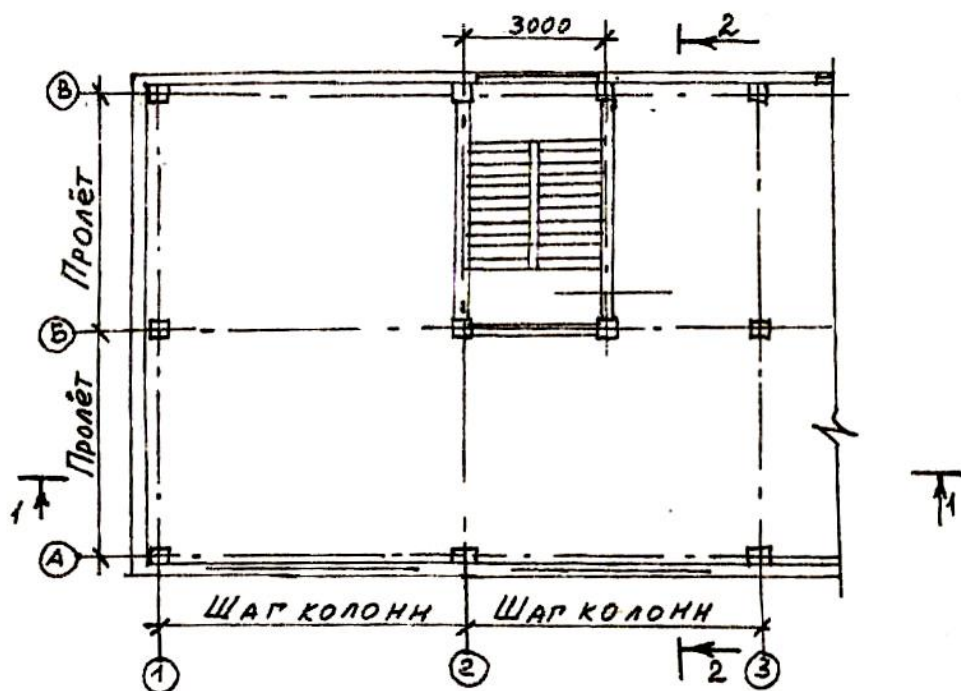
Фрагмент плана многоэтажного двухпролётного здания
